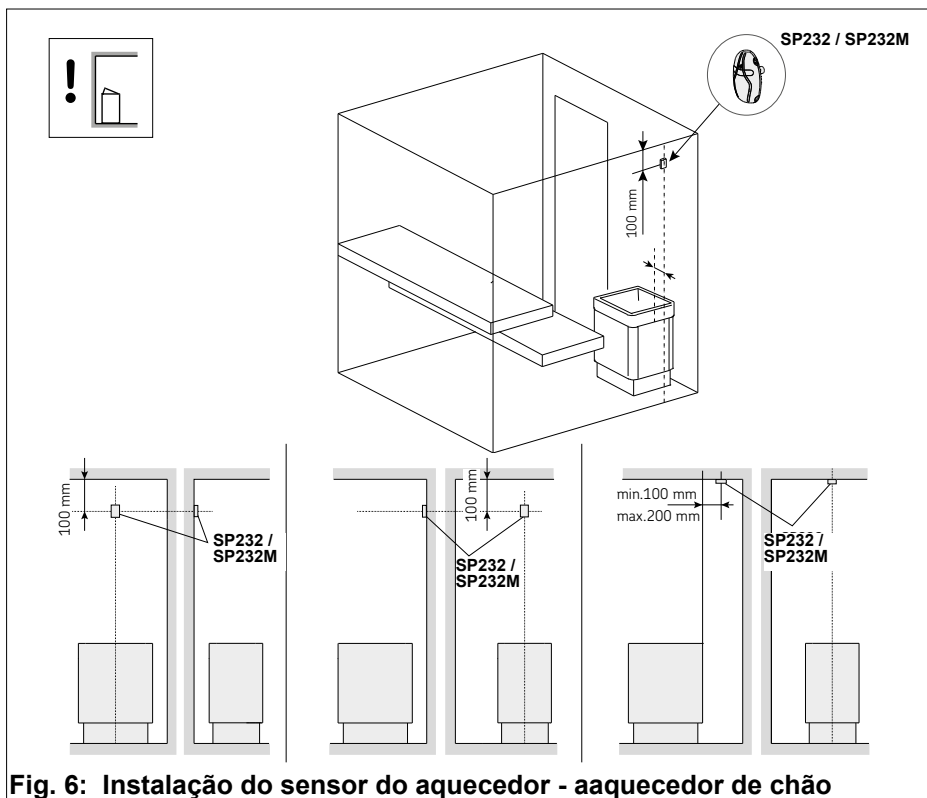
Instalação do sensor do aquecedor - aquecedor de chão
